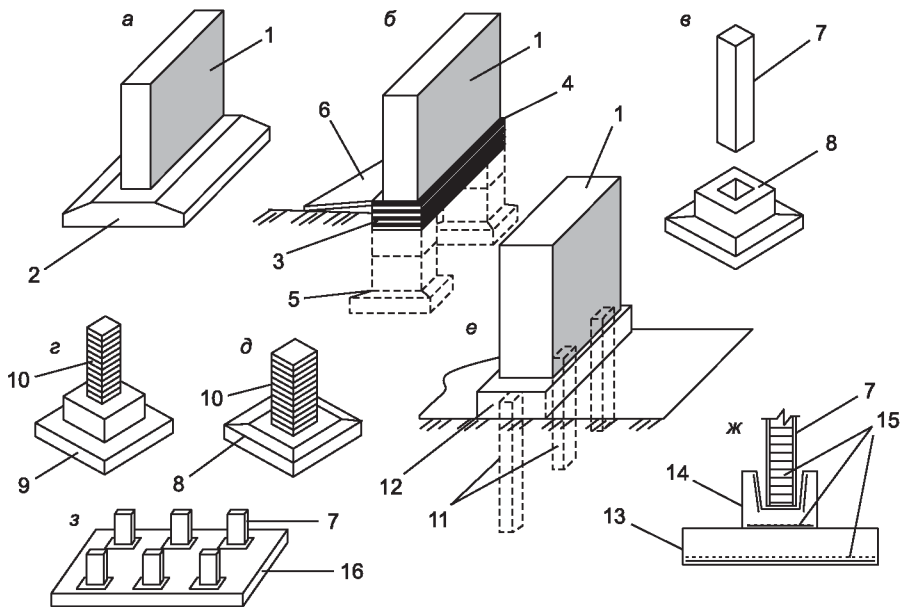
Конструктивные схемы фундаментов: а — ленточный под стены; б — столбчатый под стены; в — отдельный под колонну; г — монолитный под кирпичный столб; д — сборный под кирпичный столб; е — свайный под стену; ж — железобетонный с подколонником (в разрезе); з — сплошная плита под колонны здания; 1 — стена; 2 — фундаментная блок-подушка; 3 — железобетонная фундаментная балка; 4 — гидроизоляция; 5 — столбчатый фундамент; 6 — отмостка; 7 — железобетонная колонна; 8 — сборный под колонну; 9 — монолитный фундамент; 10 — кирпичный столб; 11 — сваи; 12 — свайный ростверк; 13 — железобетонная плита; 14 — подколонник стаканного типа; 15 — стальная арматура; 16 — монолитная железобетонная плита
